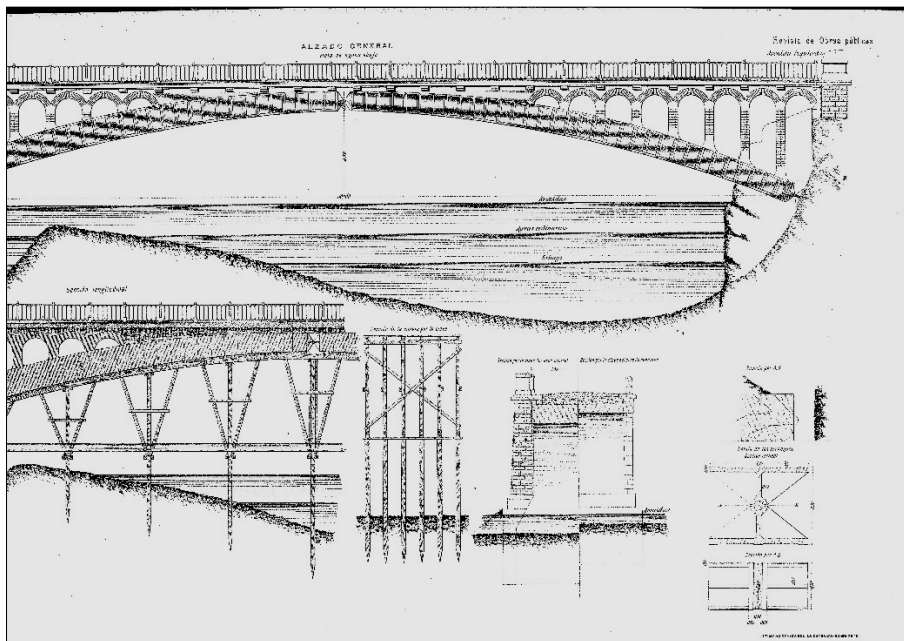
Planos del proyecto de puente de Las Segadas publicados en la Revista de Obras Públicas
